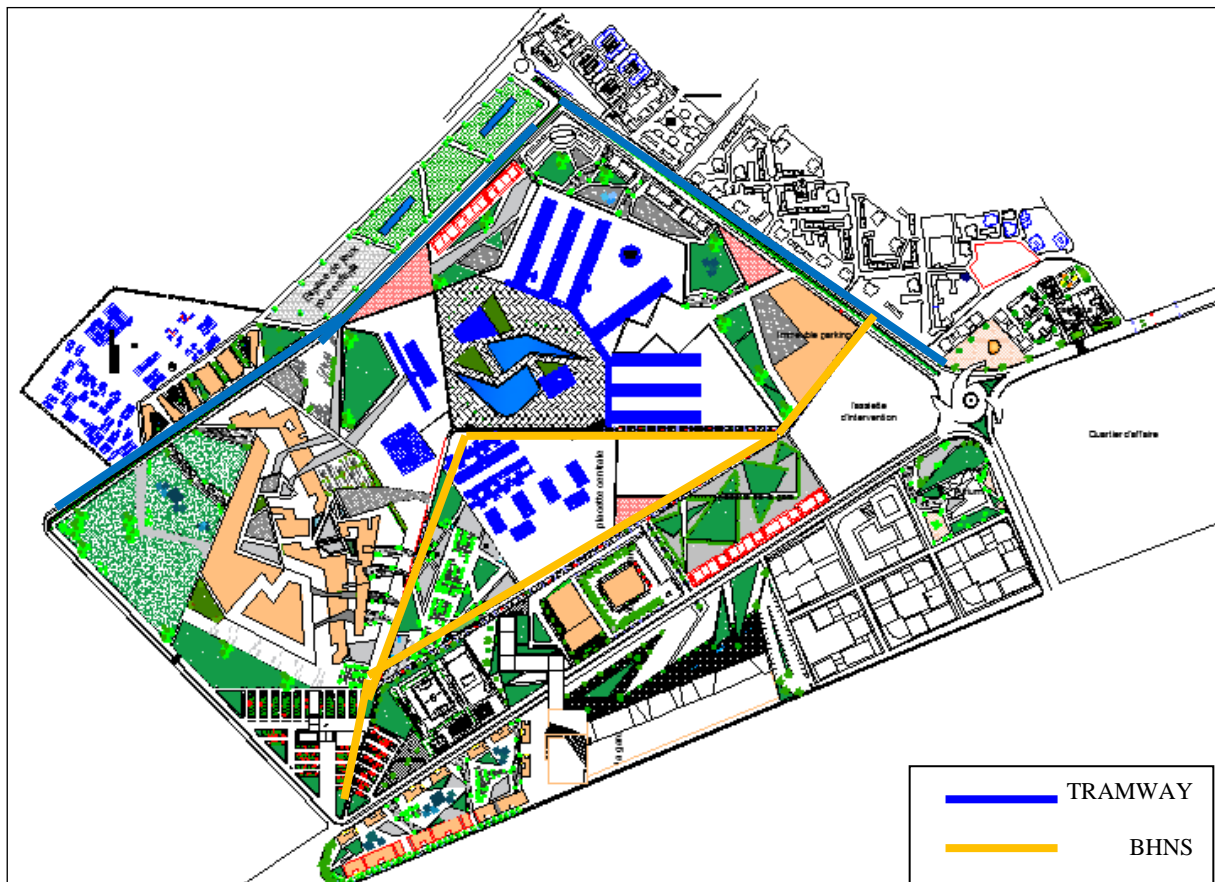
Vue en plan de la structure viaire à l'intérieur du campus
